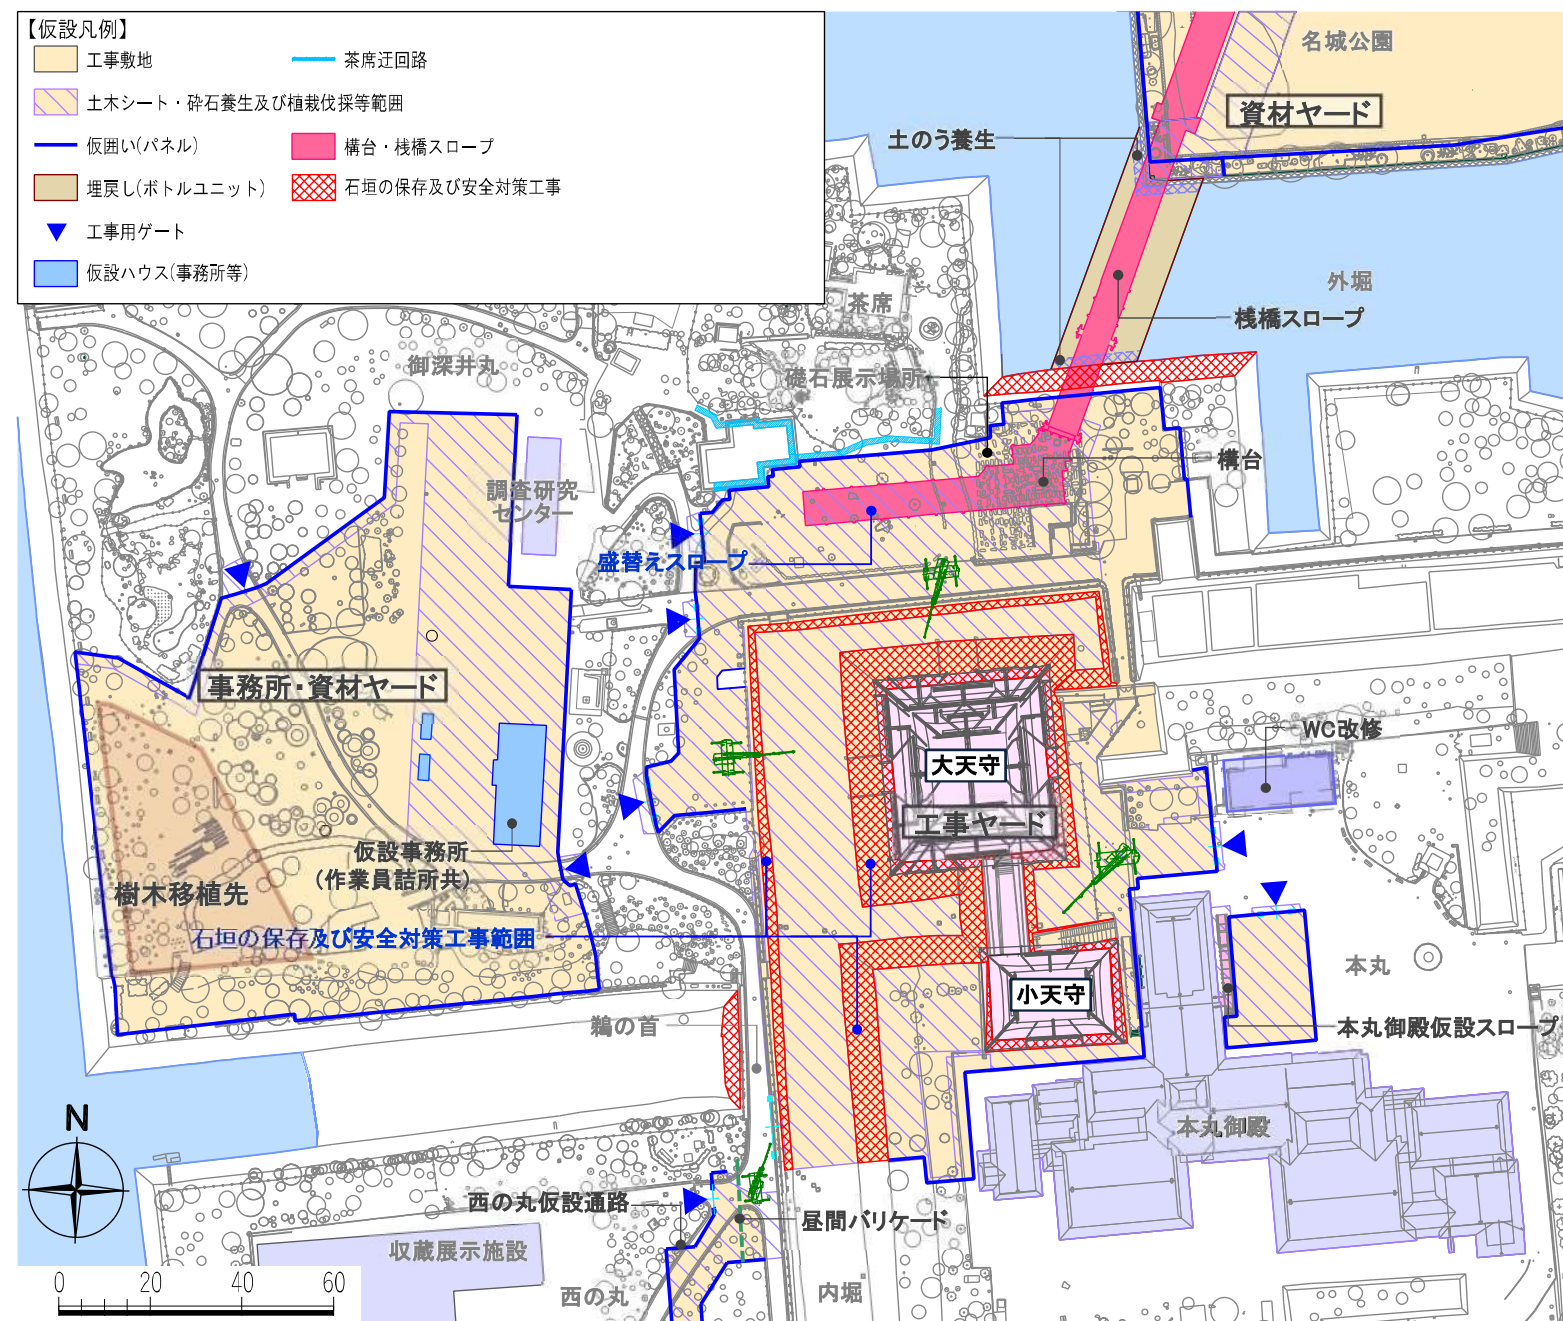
石垣の保存及び安全対策工事時の平面図
